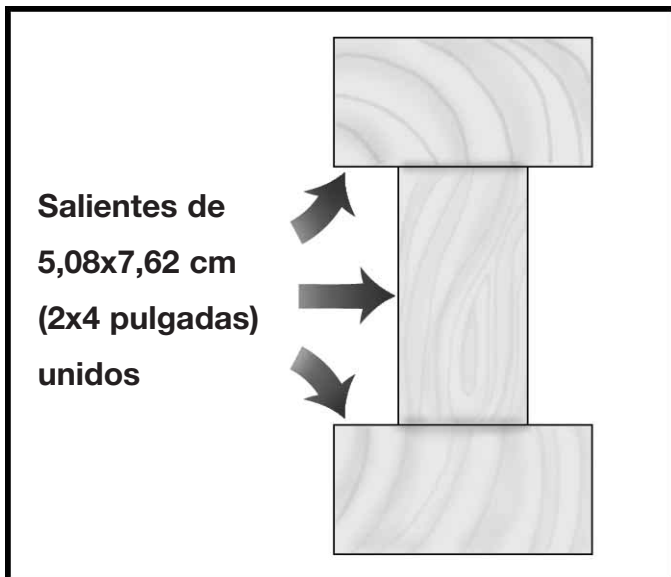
Las vigas doble T de madera ligeras están fabricadas con tablas de 5,08x7,62 cm (2x4 pulgadas) unidas.
